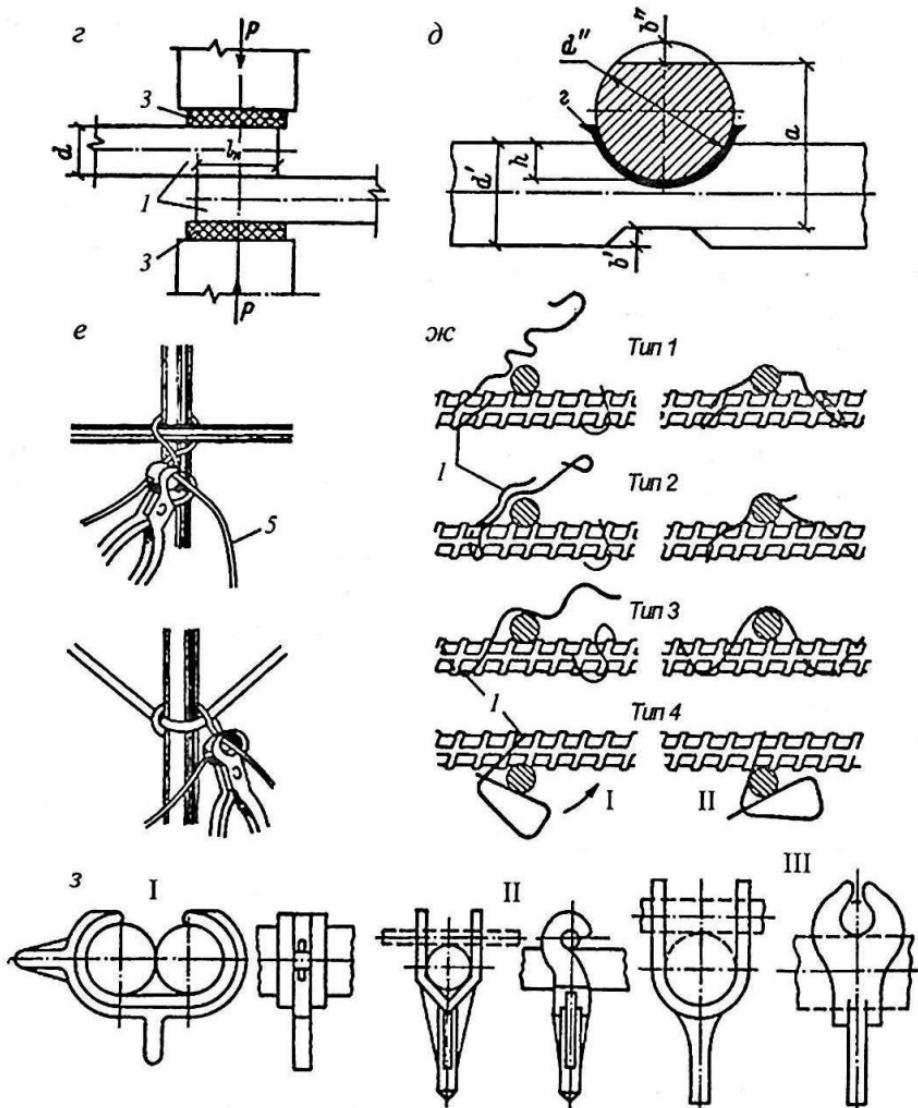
(окончание). Способы соединения арматурных стержней:
